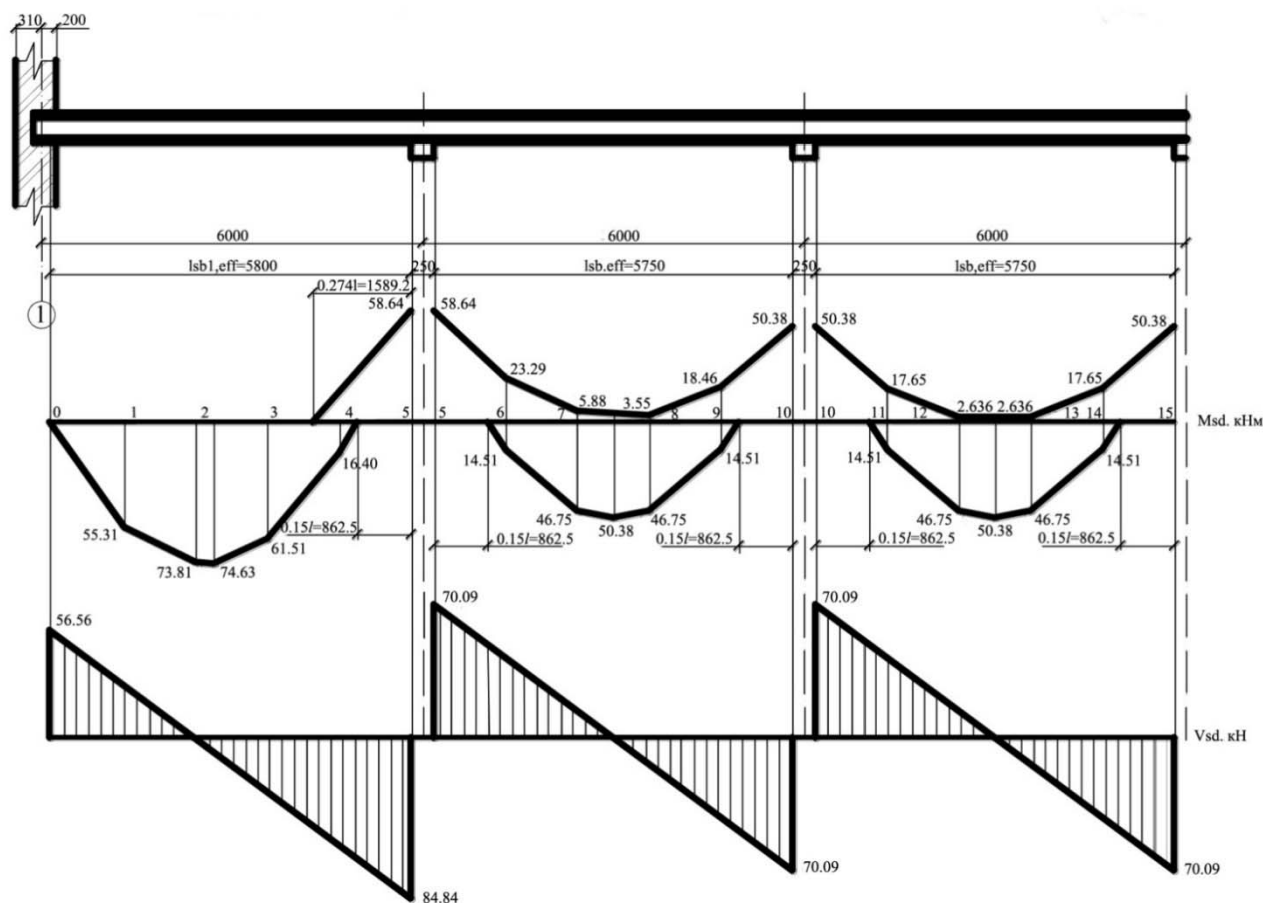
Расчетная схема балки и эпюры изгибающих моментов и поперечных сил
